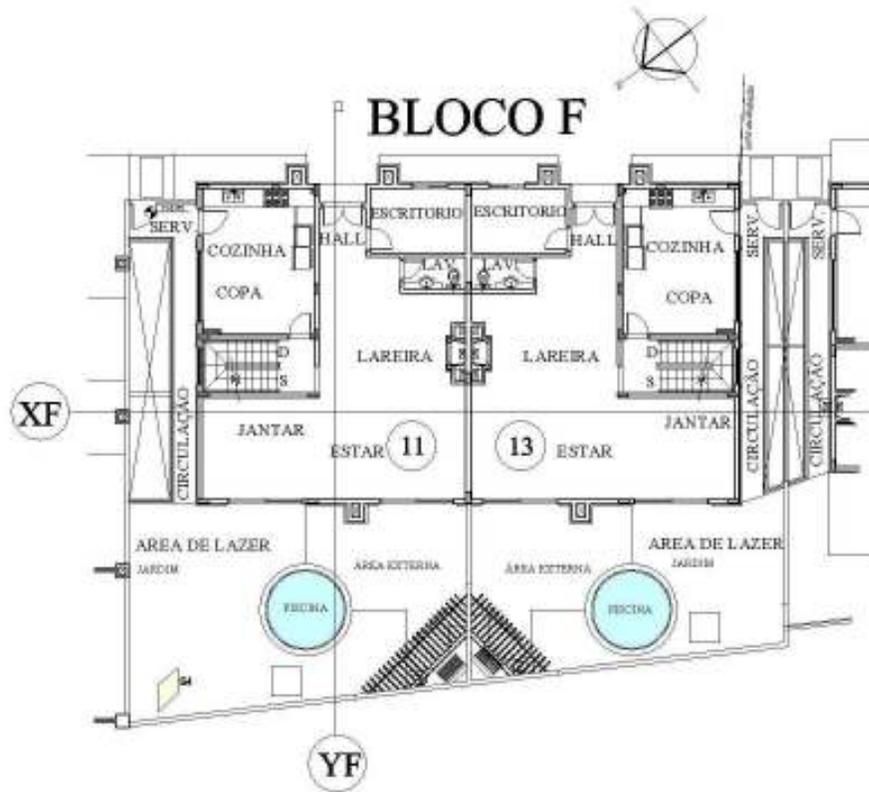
Planta do pavimento térreo – tipo 1
